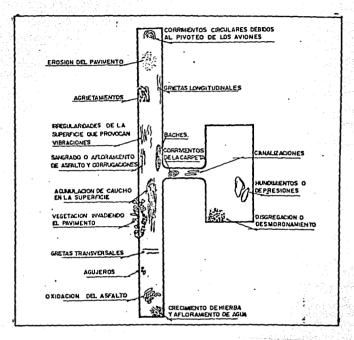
Conservación y detallos a observar en pavimentos flexibles.
